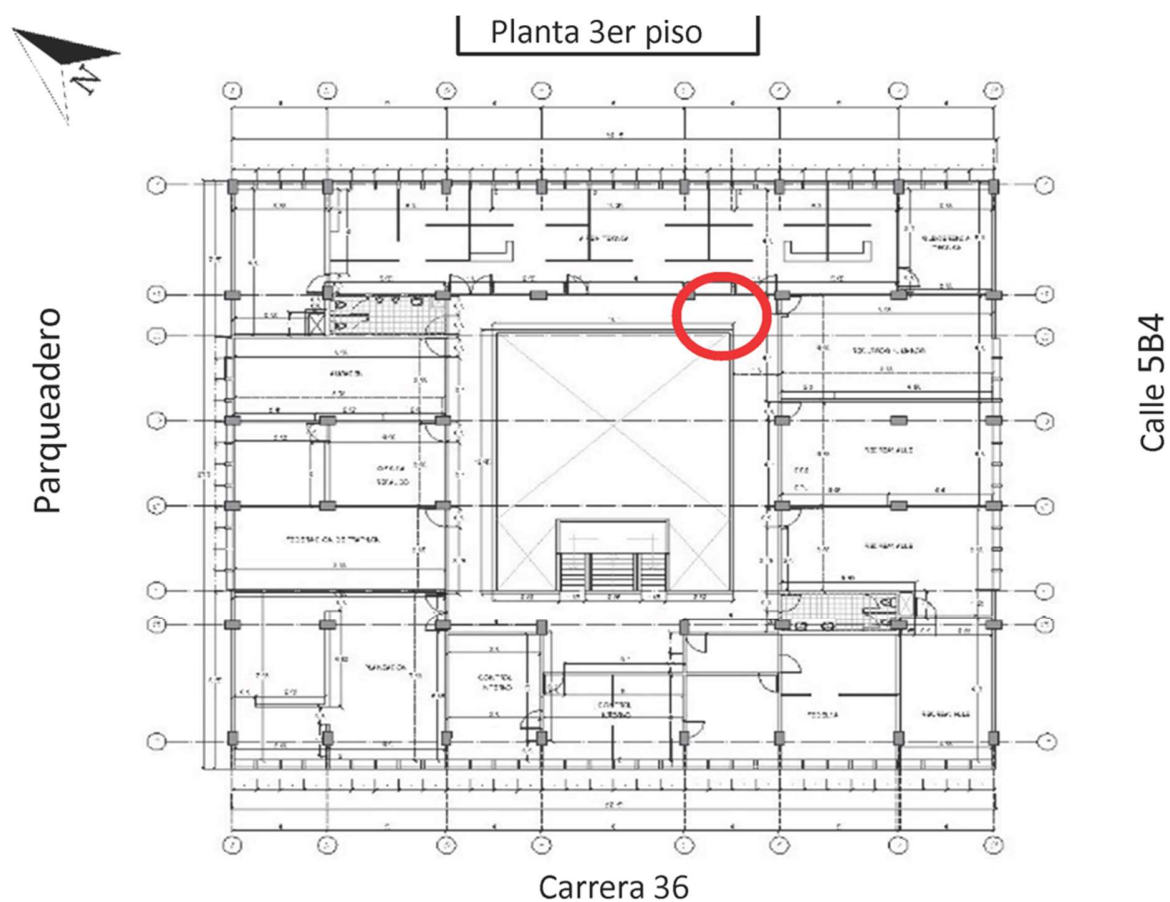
Localización de lesión Grieta en losa de cubierta (GL1).
